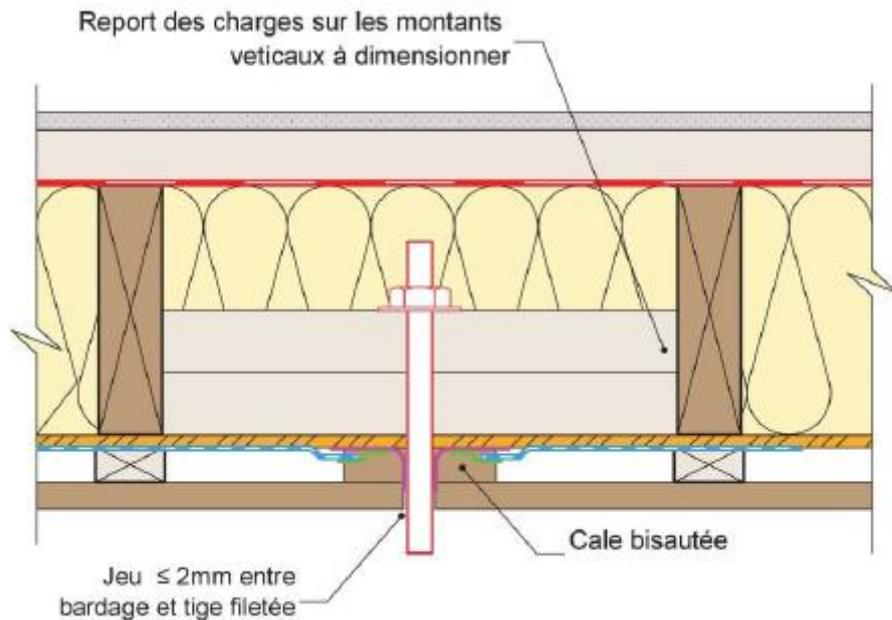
Exemple de traversée bardage / pare-pluie – – coupe horizontale
